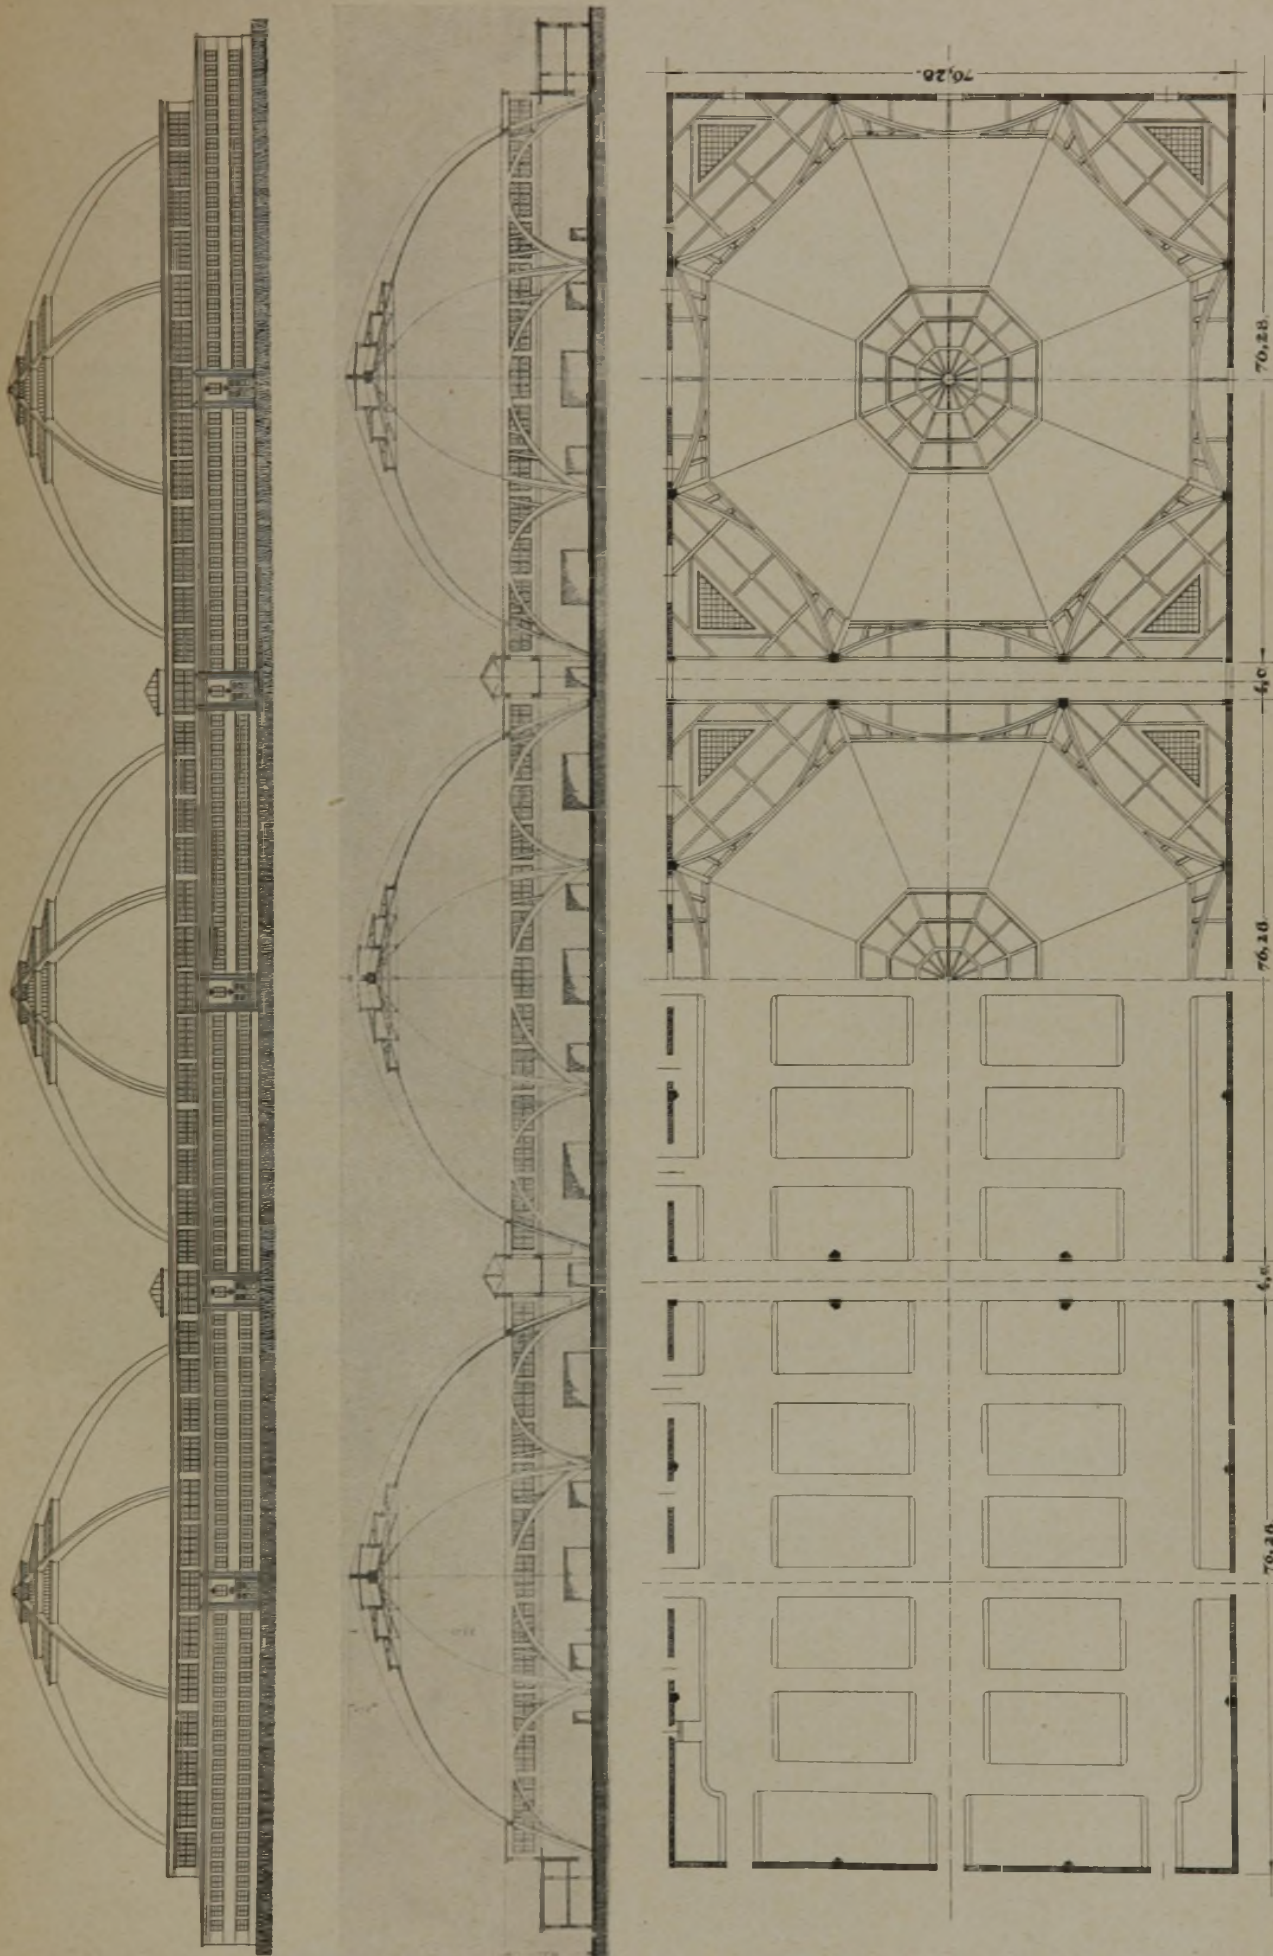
Ansicht, Längsschnitt und Grundriß bzw. Aufsicht auf die Konstruktion der Markthalle Leipzig. (1:1200.) Eine neue Konstruktion für Großmarkthallen in Leipzig.
